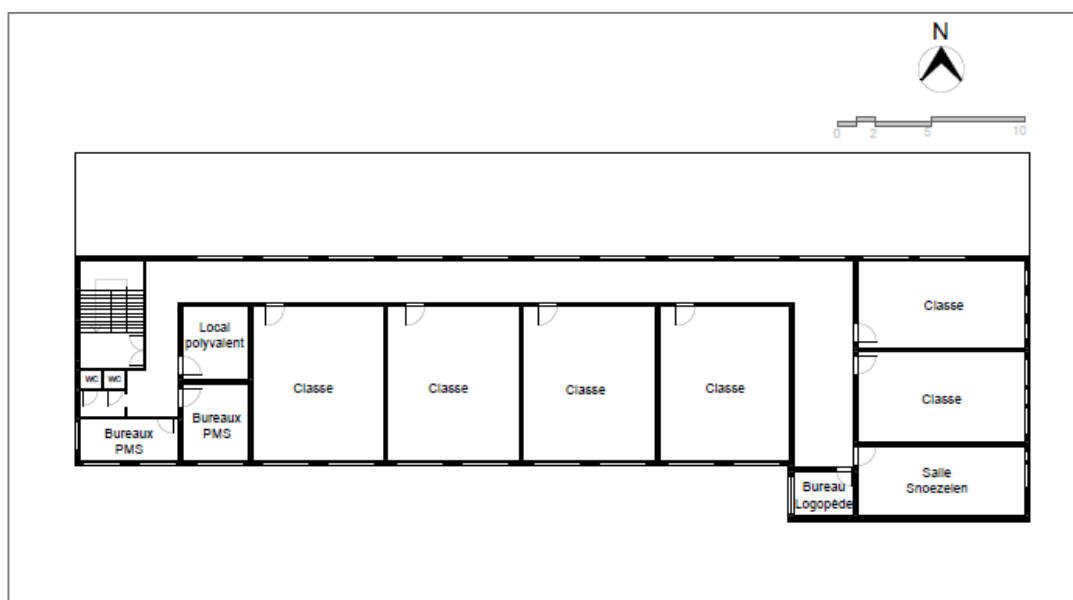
Plan du 1er étage – Saint-Joseph (Daumalle, 2026)
